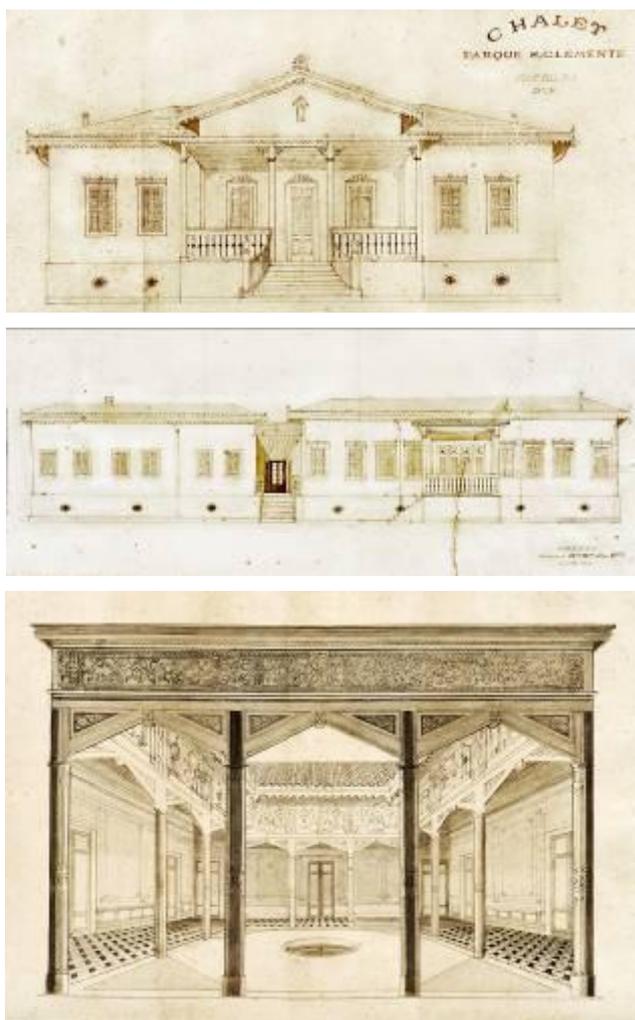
, 88 e 89: Desenhos da Fachada frontal, Fachada lateral e Pátio Central do Chalet do Parque São Clemente.
